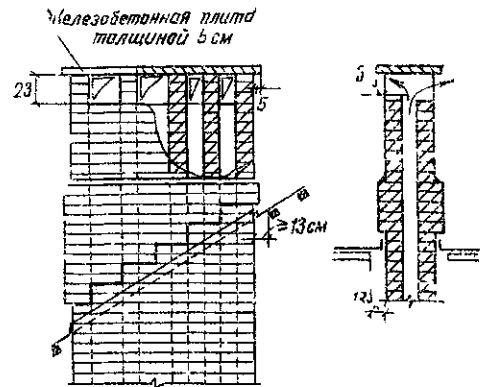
16 Схема дымовых каналов, перекрытых железобетонной плитой
